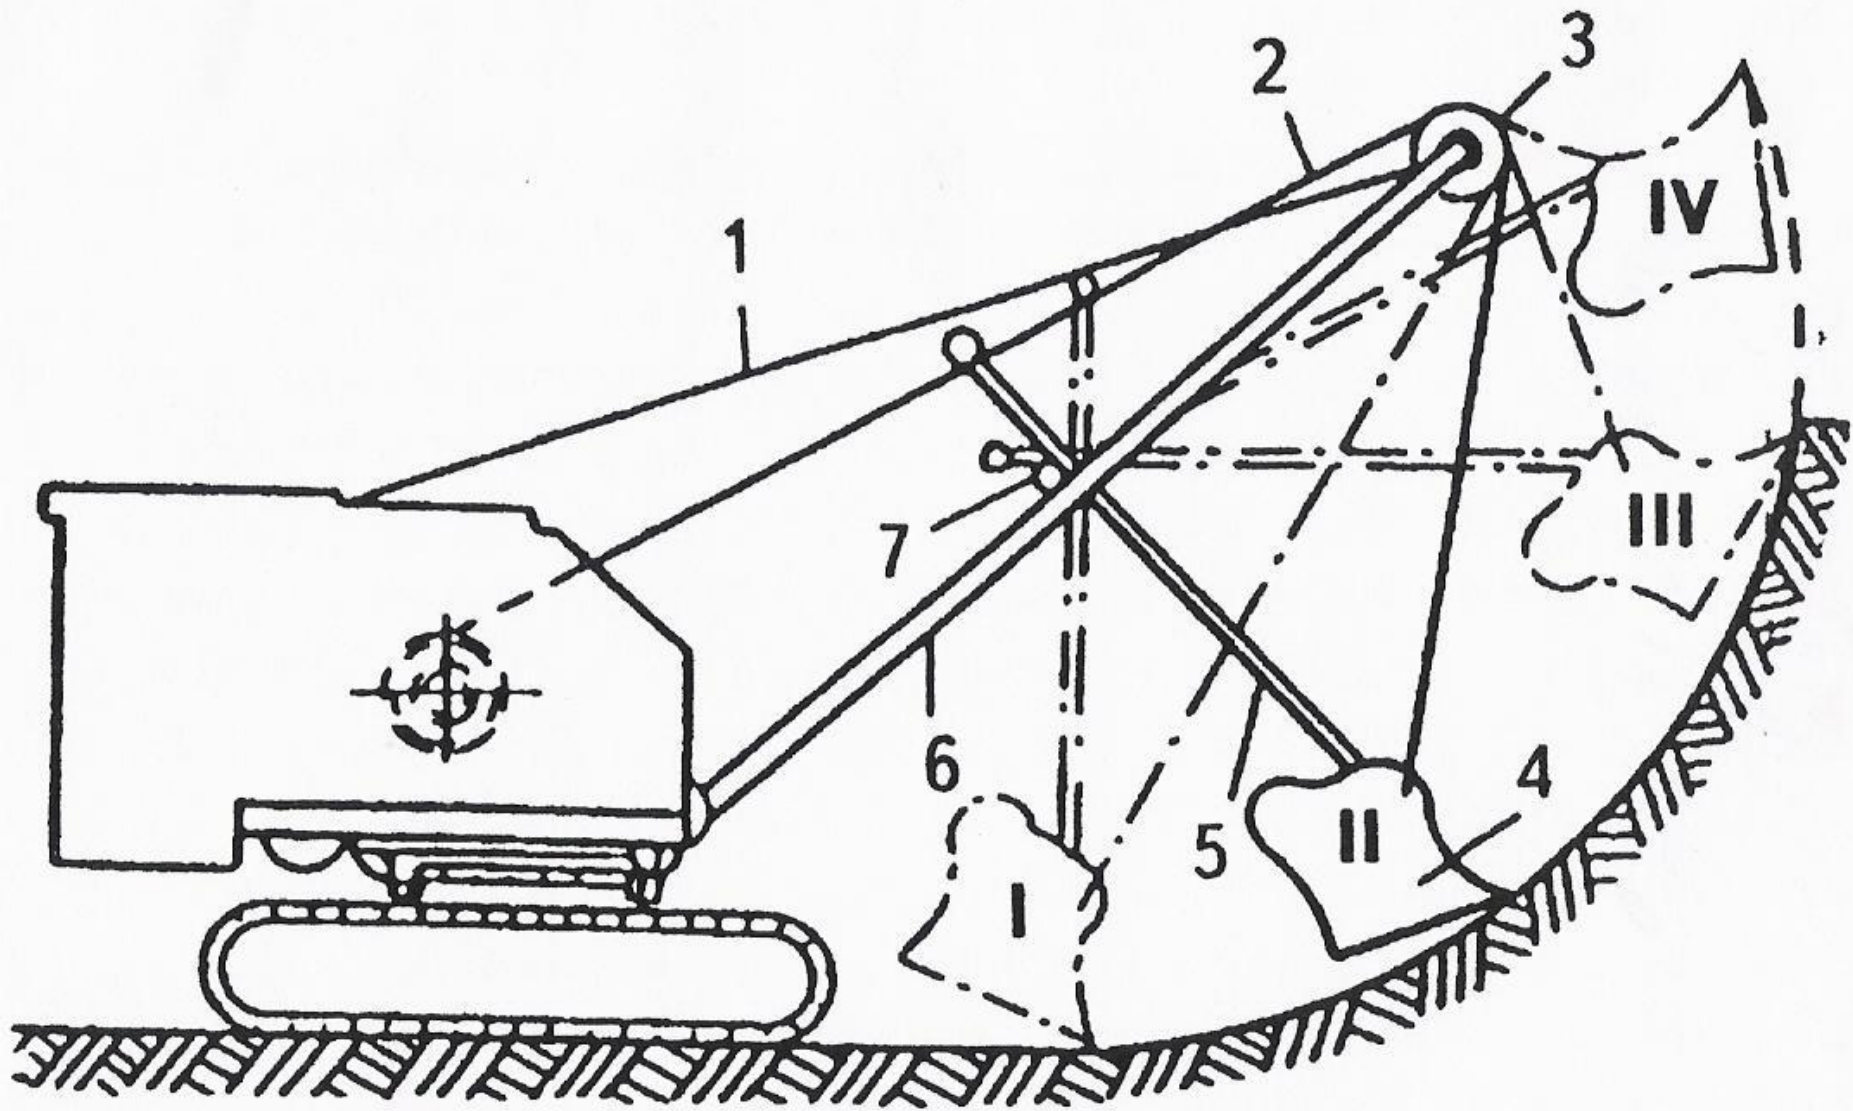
Прямая лопата: 1 – канат подъема стрелы; 2 – подъемный канат; 3 – головной блок; 4 – ковш; 5 – рукоять; 6 – стрела; 7 – седловой подшипник
